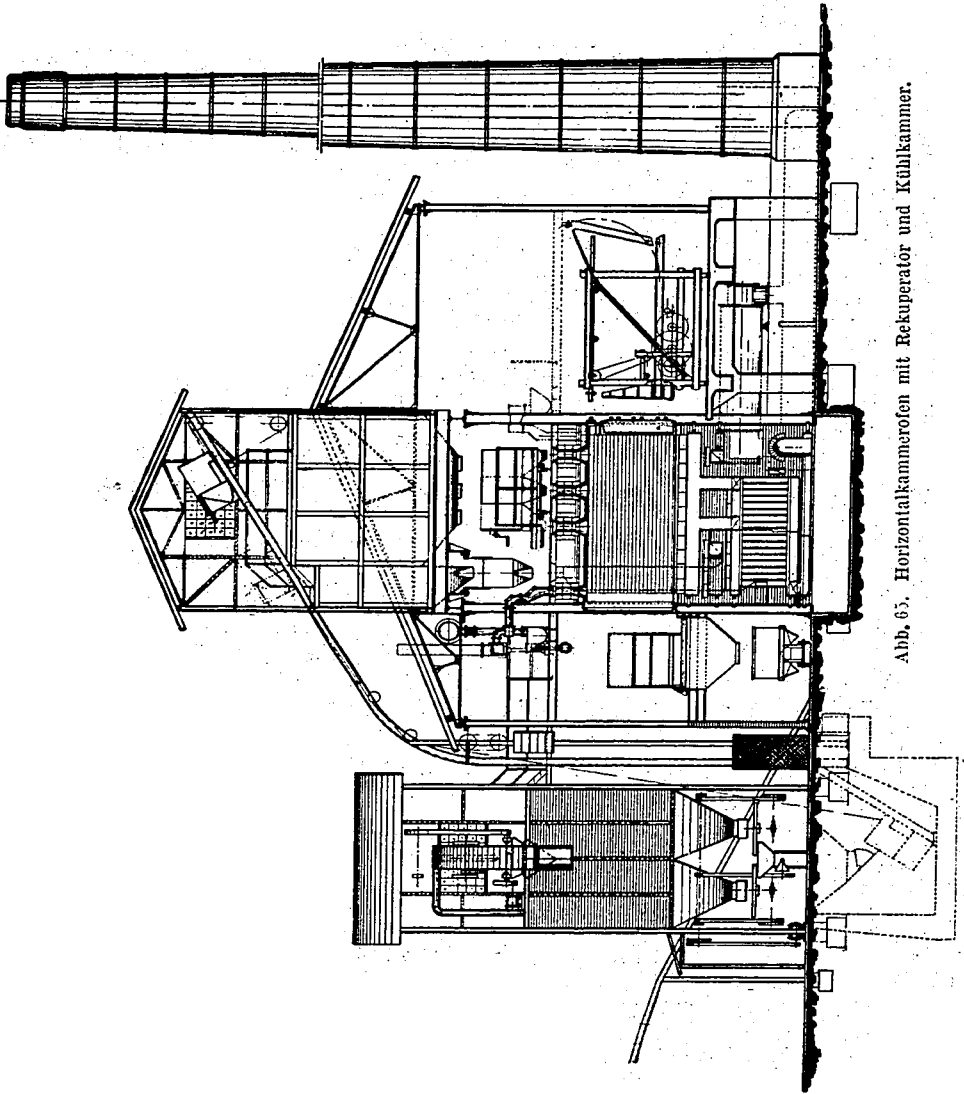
Horizontalkammerofen mit Rekuperator und Kühlkammer.
